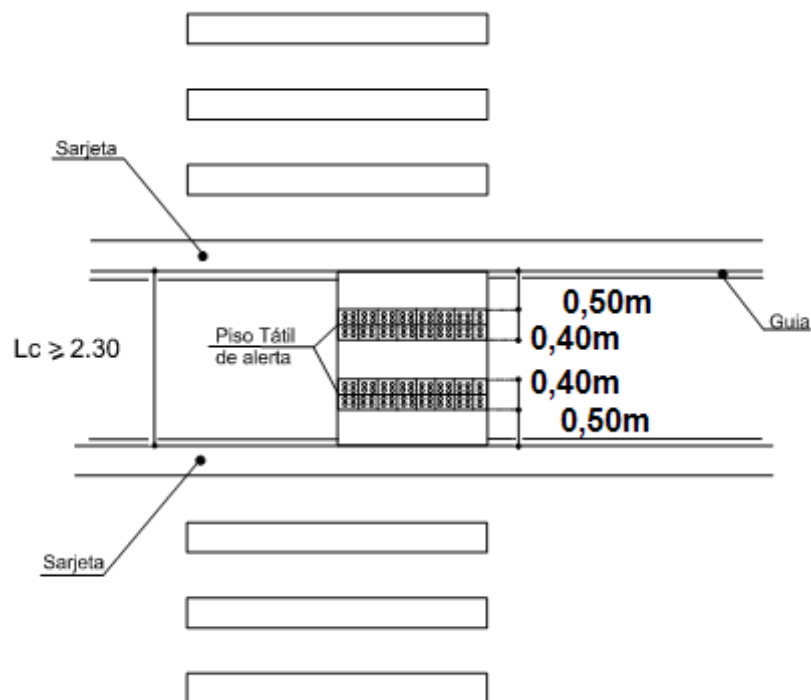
Planta - Rebaixamento em canteiro central superior a 2,30m.
